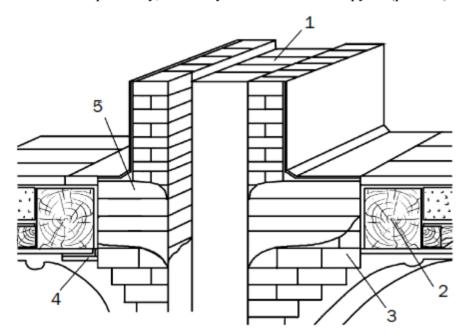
Разделка в месте выхода дымовой трубы в междуэтажном перекрытии: 1 — дымовой канал; 2 — балка перекрытия; 3 — разделка в 1 1/2 кирпича; 4 — асбест (2 слоя); 5 — разделка в 1 кирпич Поскольку деревянное строение подвержено осадке, запрещается осуществлять жесткое сочленение перекрытия и дымовой трубы во избежание ее разрушения.
